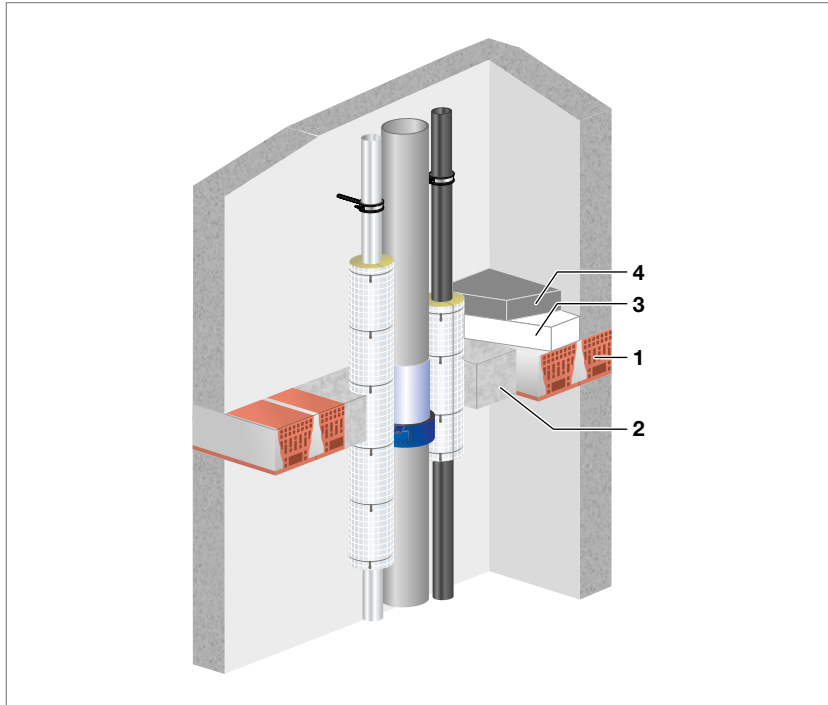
Stahlbeton- und Spannbeton-, Balken- und Rippendecken aus Normalbeton mit Zwischenbauteilen „F 90“-Konstruktion
